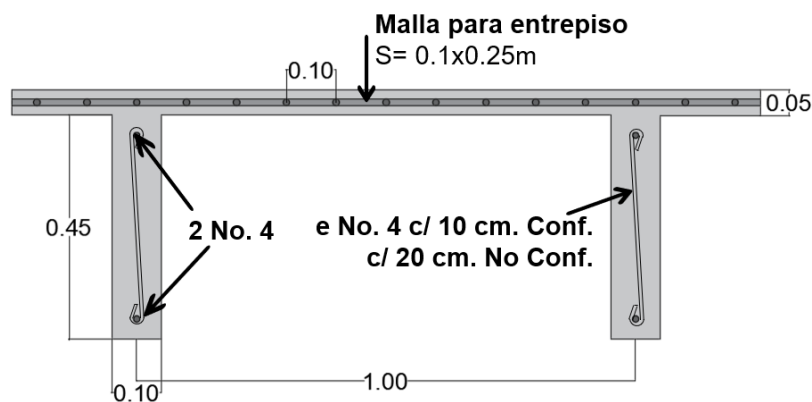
Sección transversal tipo para placa aligerada en cubierta del bloque A, el detalle de los cálculos se encuentra en el Apéndice L.
